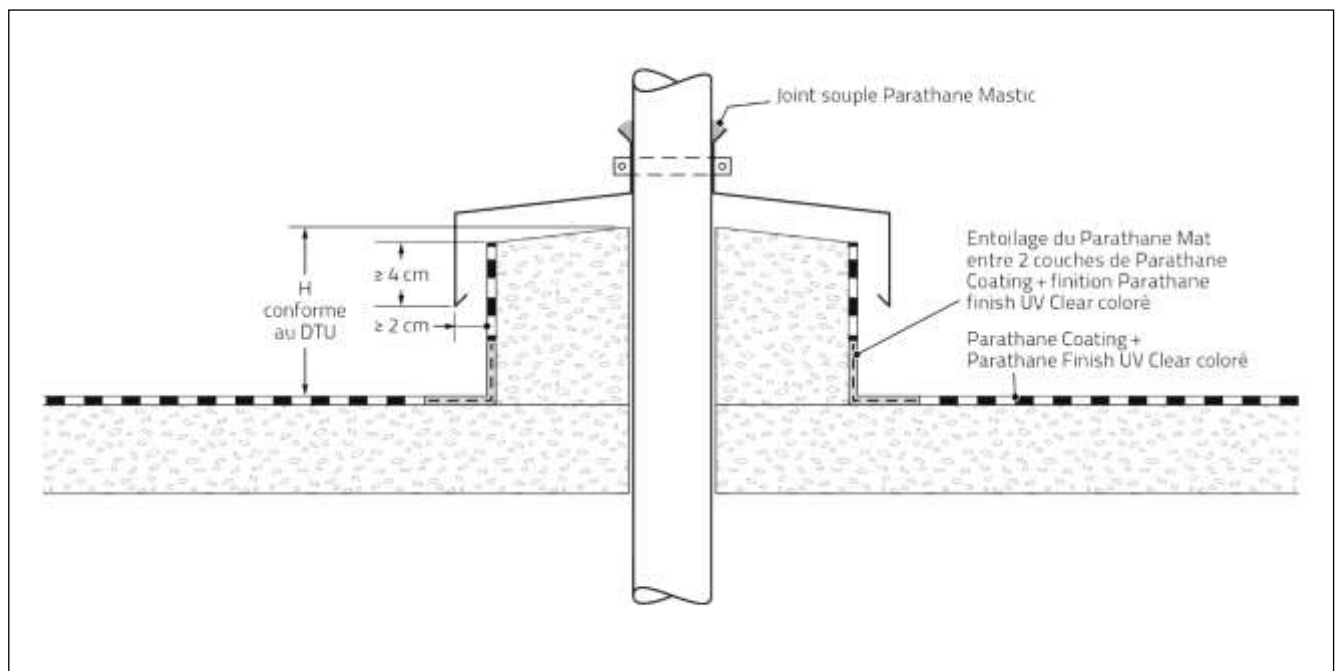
bis – Traversée de toitures accessible avec dé en béton
